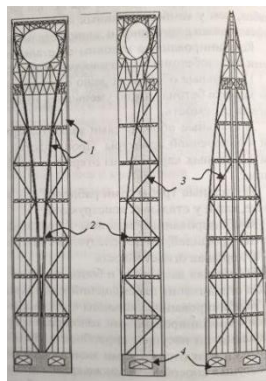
Схема конструктивной системы финансового центра Шанхая: 1 – главная колонна; 2 – ленточная ферма; 3 –раскосы; 4-железобетонная контурная стена
